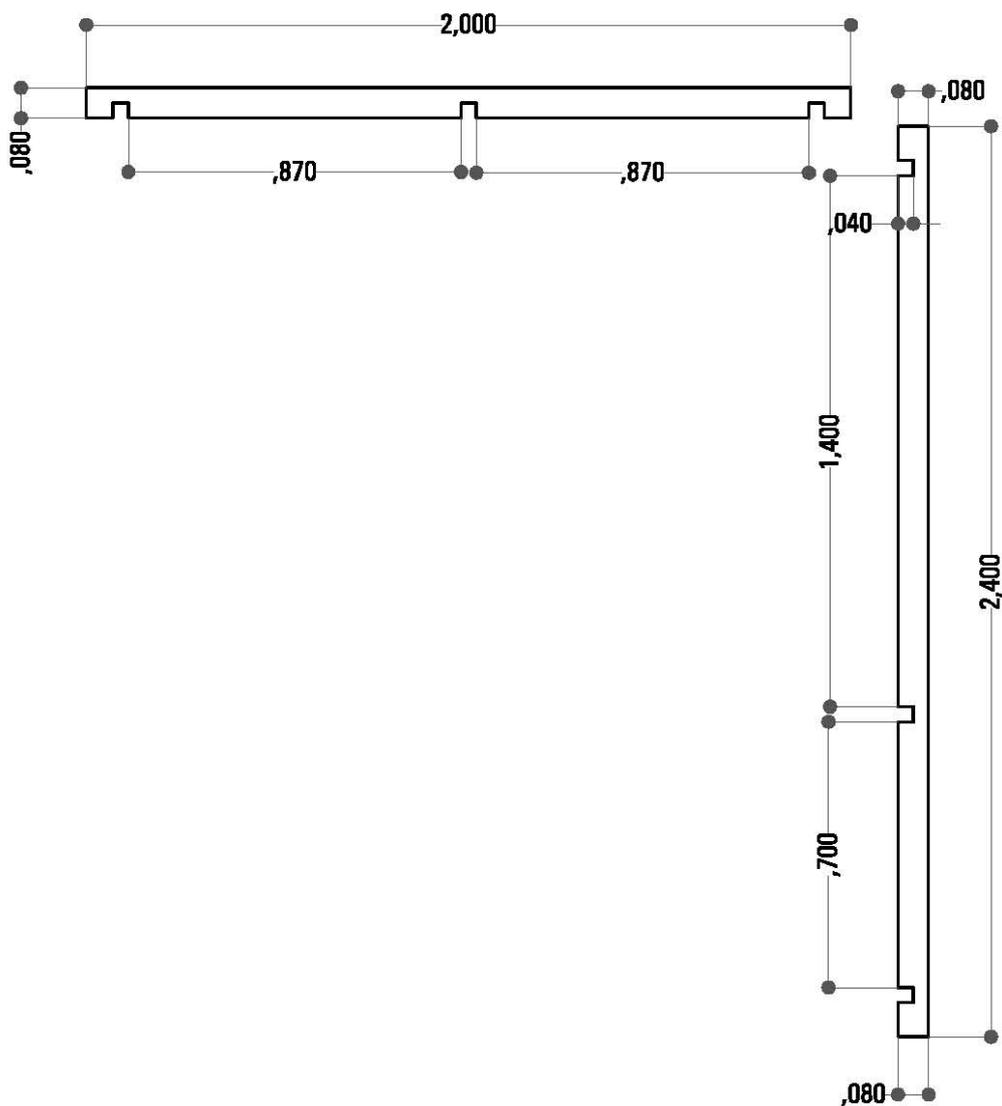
Les pièces essentielles d'un jeu de coffrage en bois pour 4 dalles d'une latrine VIP familiale
